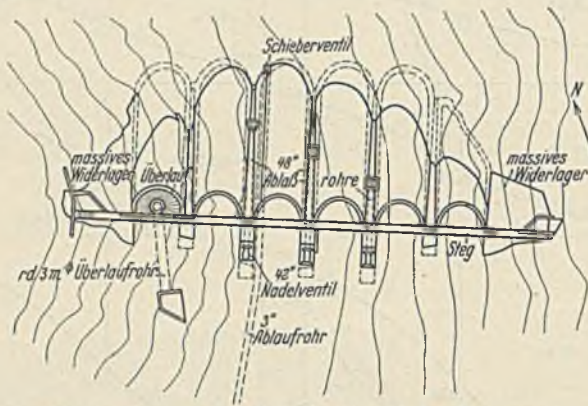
Lageplan mit Aufsicht auf die Staumauer.
